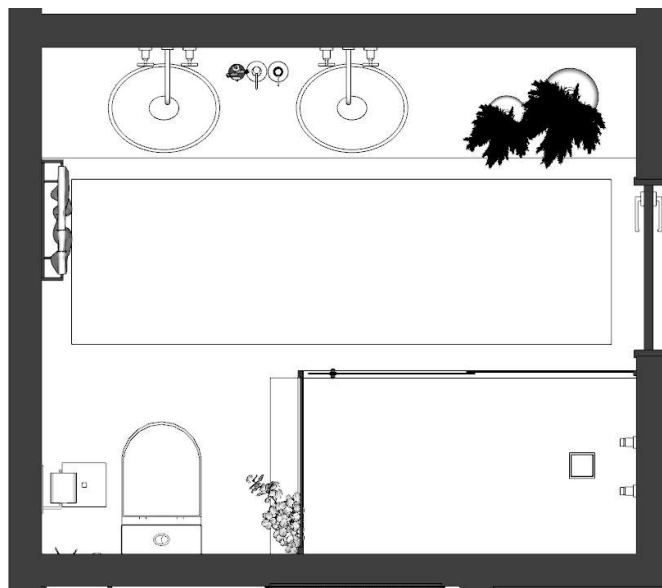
Planta s/escala, Instalação sanitária. *Fonte:* Autora.
